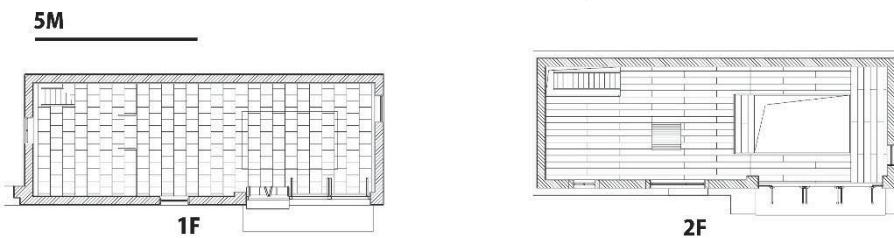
叢桂西街 20 番の平面図（資料提供：中山大学）
